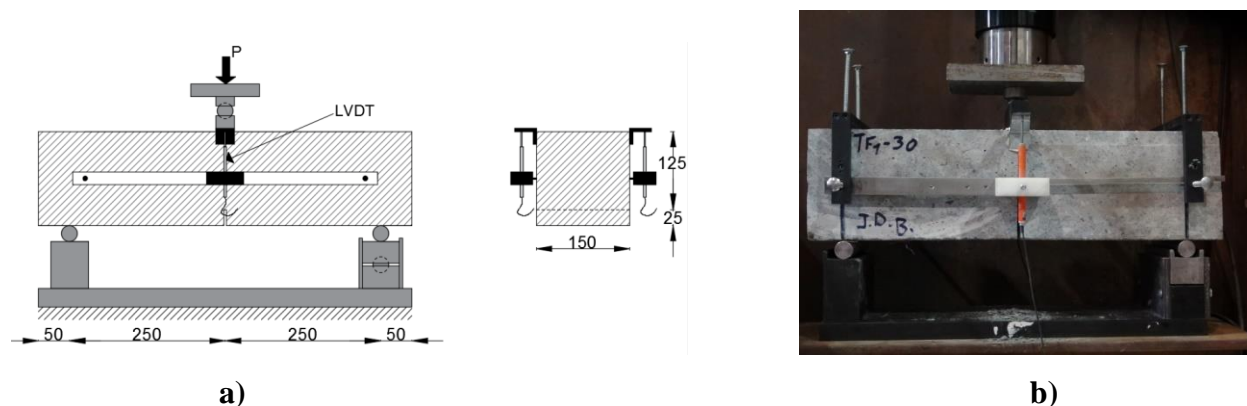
Montage expérimental de l'essai de flexion trois points EN14651, a) Schéma b) Photo
